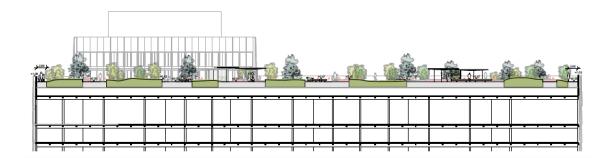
Schnitt durch den Dachgarten mit Blick auf Bauteil B Quelle: Atelier Loidl
